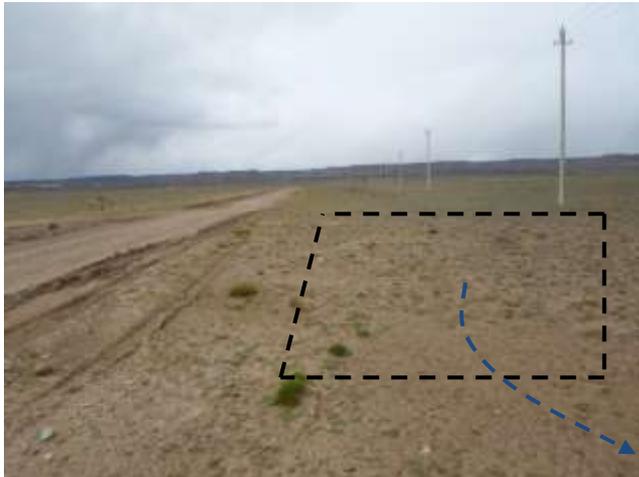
Inicio de línea de inyección en futuro satélite inyector LCO. Foto en dirección E.
